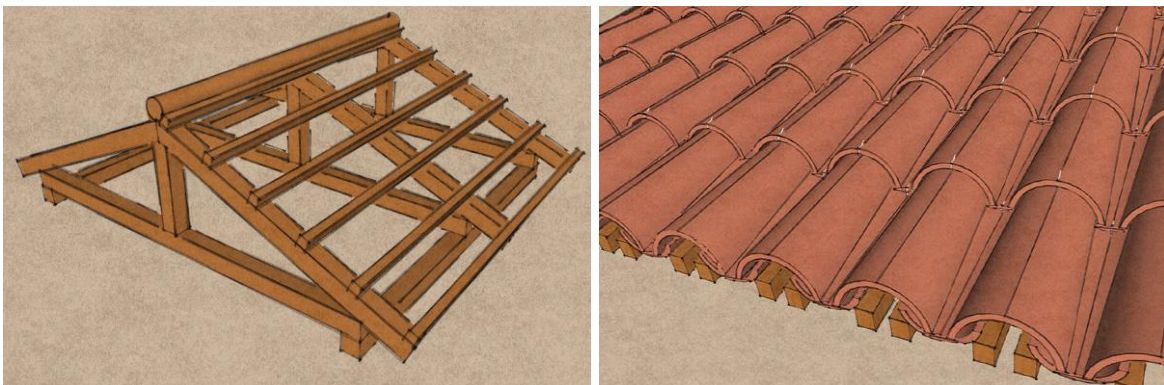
Armado de cubierta. Fuente: Pinos & Baculima, 2013.
